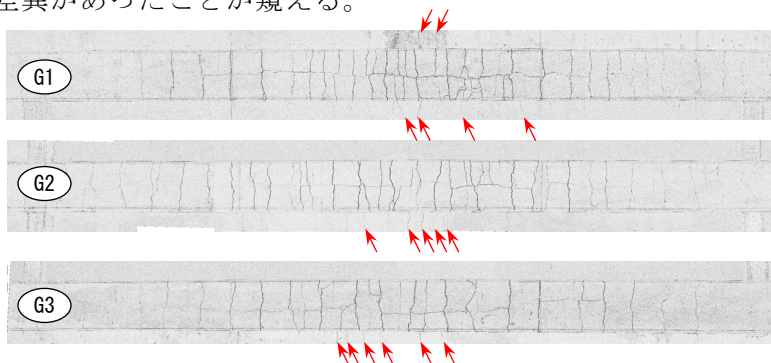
桁下面のひび割れ状況 (第3径間の支間中央部付近)
